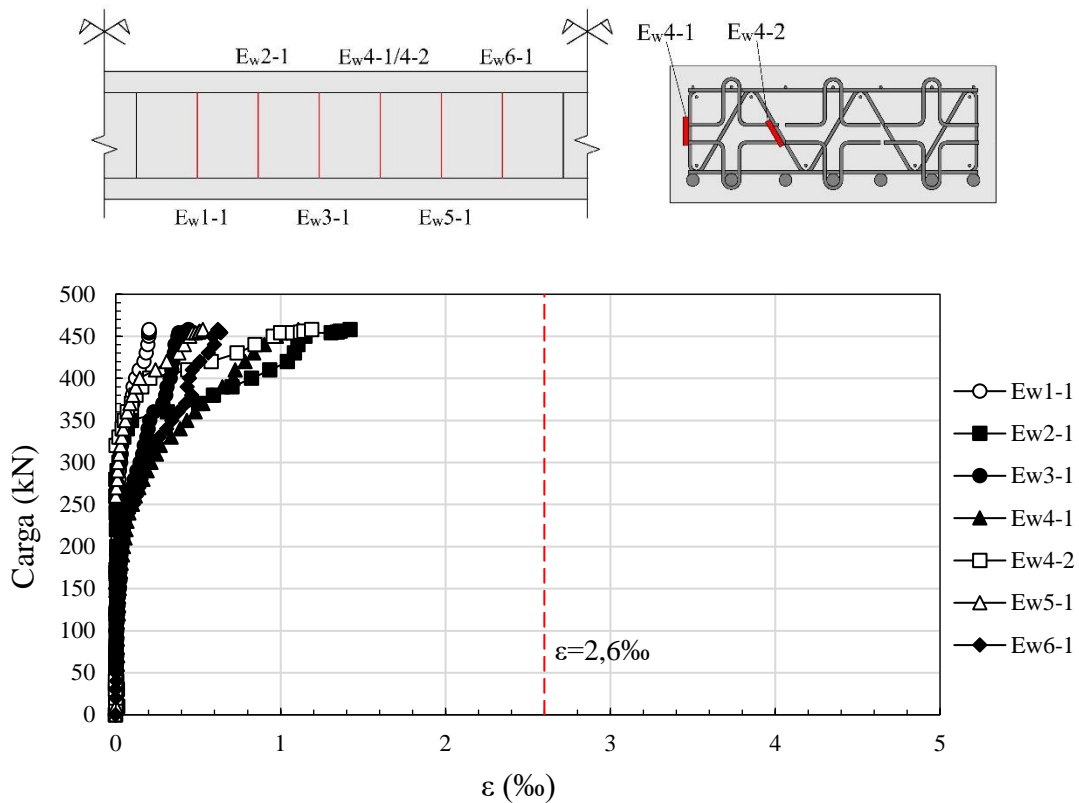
Carga x Deformação dos estribos da viga W-3.5-0.25
